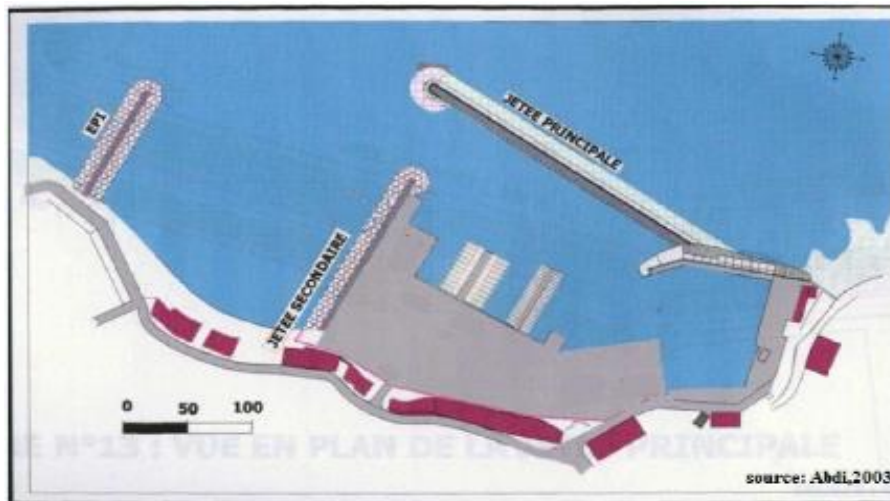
Plan de Masse du nouveau port d'El Djamilia (Abdi, 2003)
